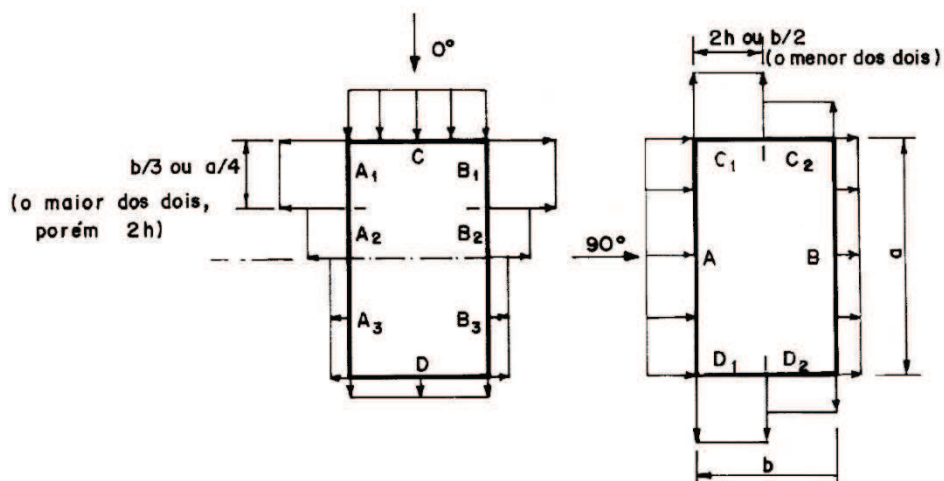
indicação em planta dos coeficientes de pressão e forma externos para paredes de edificações de planta retangular.
